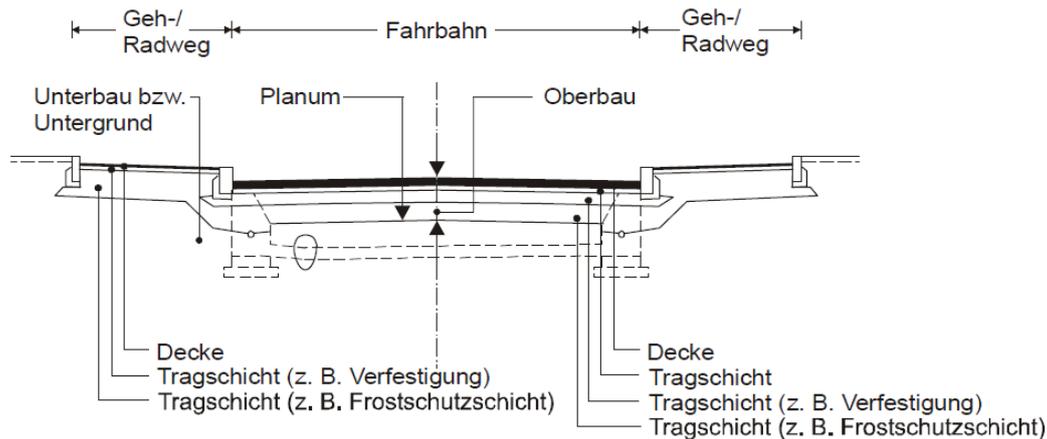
Beispielhafter Straßenaufbau außerhalb geschlossener Ortslage
